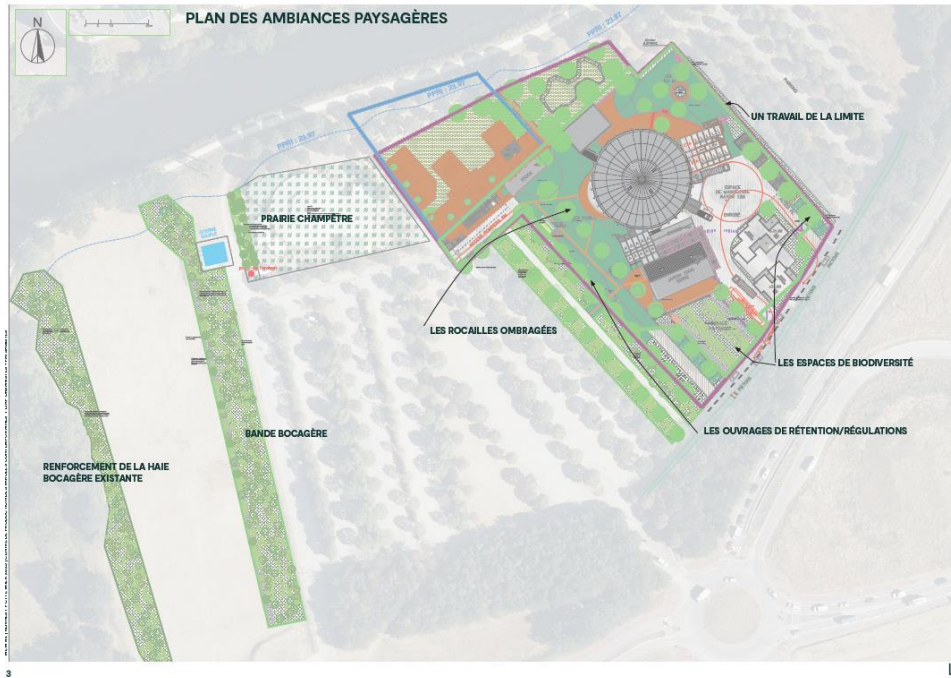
Plan général du projet paysager (Source LIAP, février 2024)
